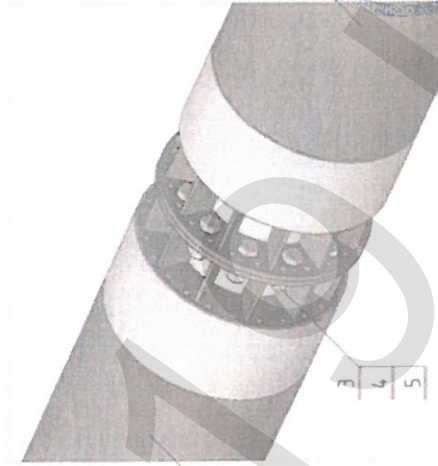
Общий вид сборной железобетонной стойки СК 26.1-2.3 Сб
